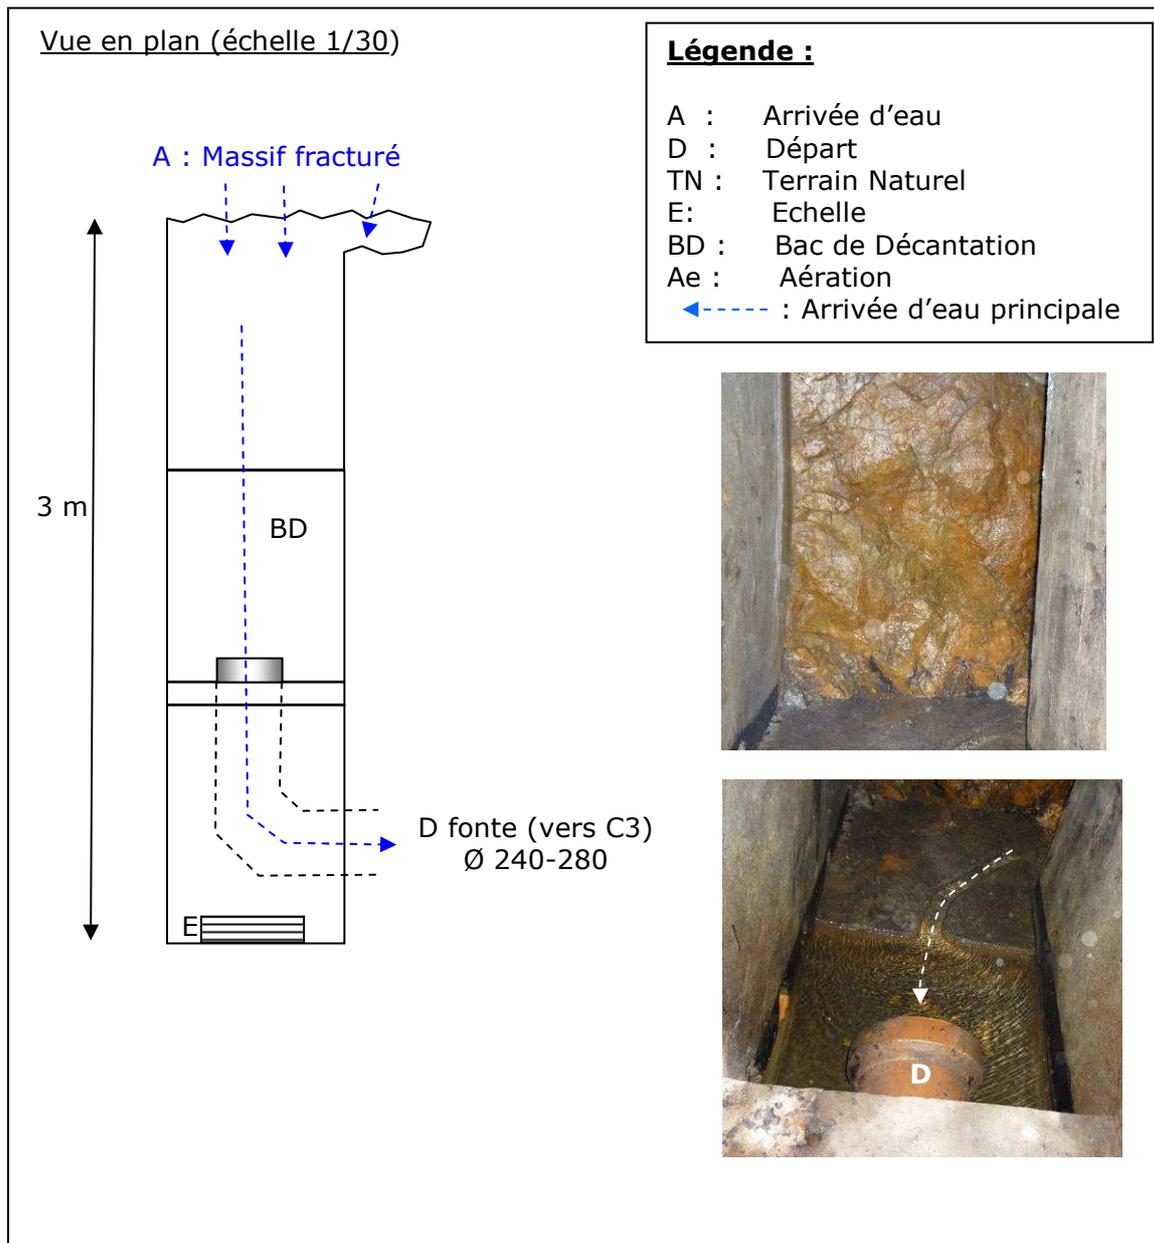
Vue en plan de l'ouvrage de Lempret C4
